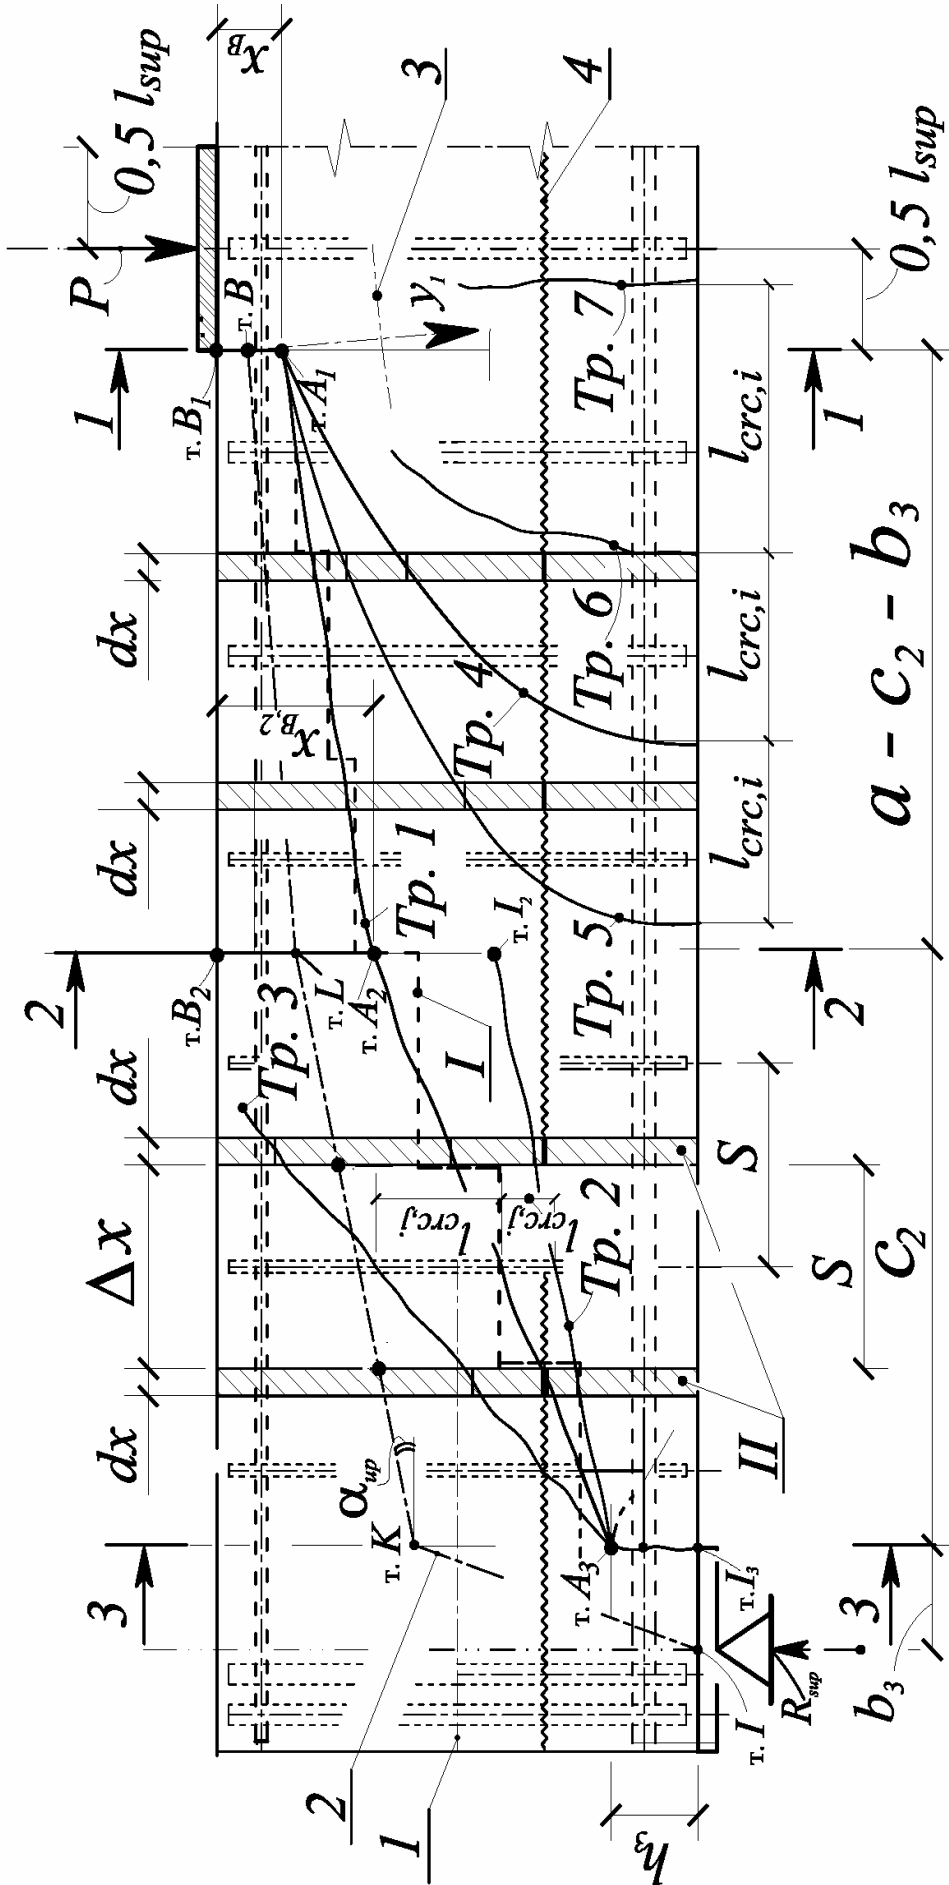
Схема трещин в железобетонных составных конструкциях, выделение полосок Δx для представительного объема бетона, формирующего расчетную схему второго уровня при определении $l_{crc,i}$ (рис. 3) и элементарных полосок $dx = 1$ для определения жесткостей поперечных сечений (рис. 5)
